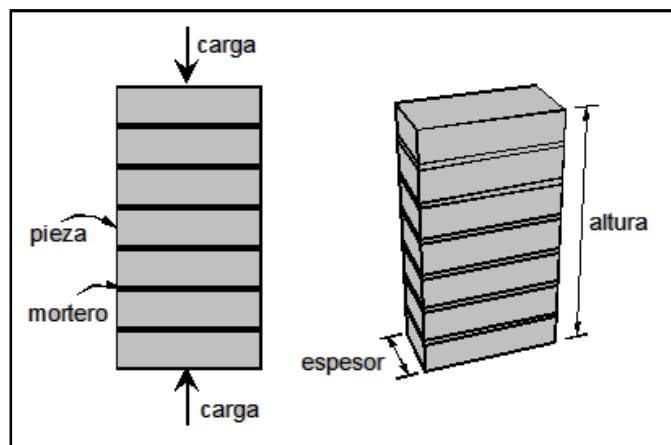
Esquema del ensayo sobre pilas de mampostería.
